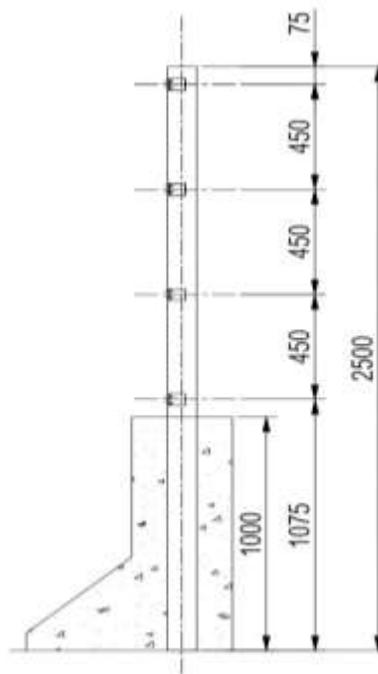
Detalhamento das estruturas verticais para o gradil de proteção para barreira baixa.
